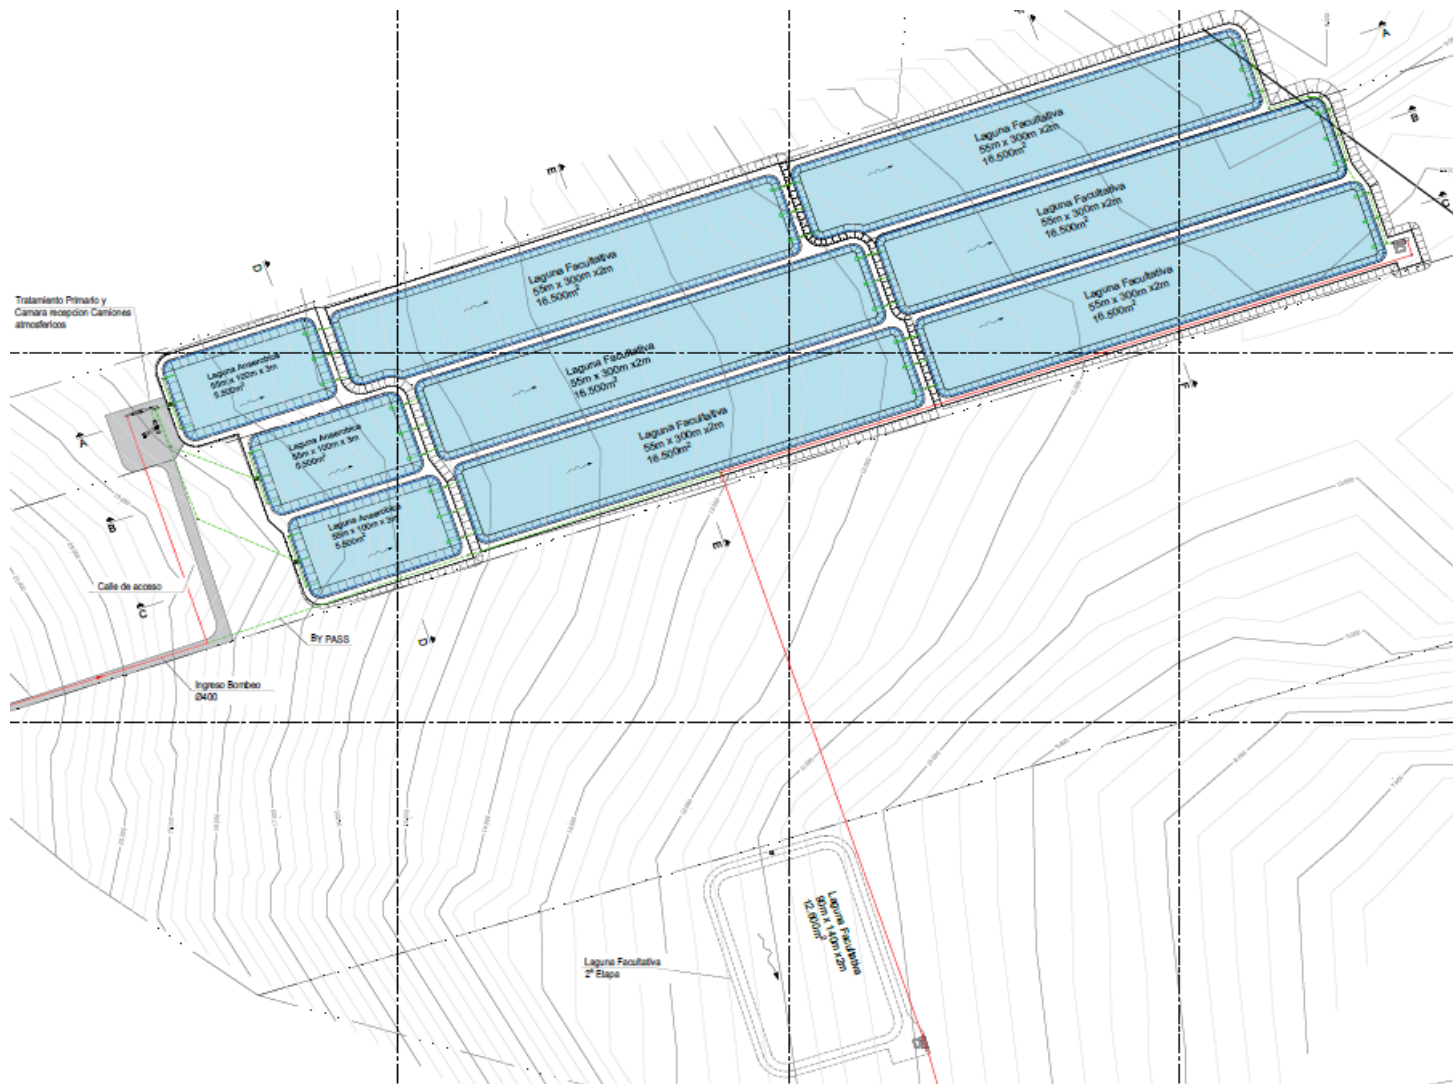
Planimetría general de la Planta de Tratamiento para la alternativa seleccionada
